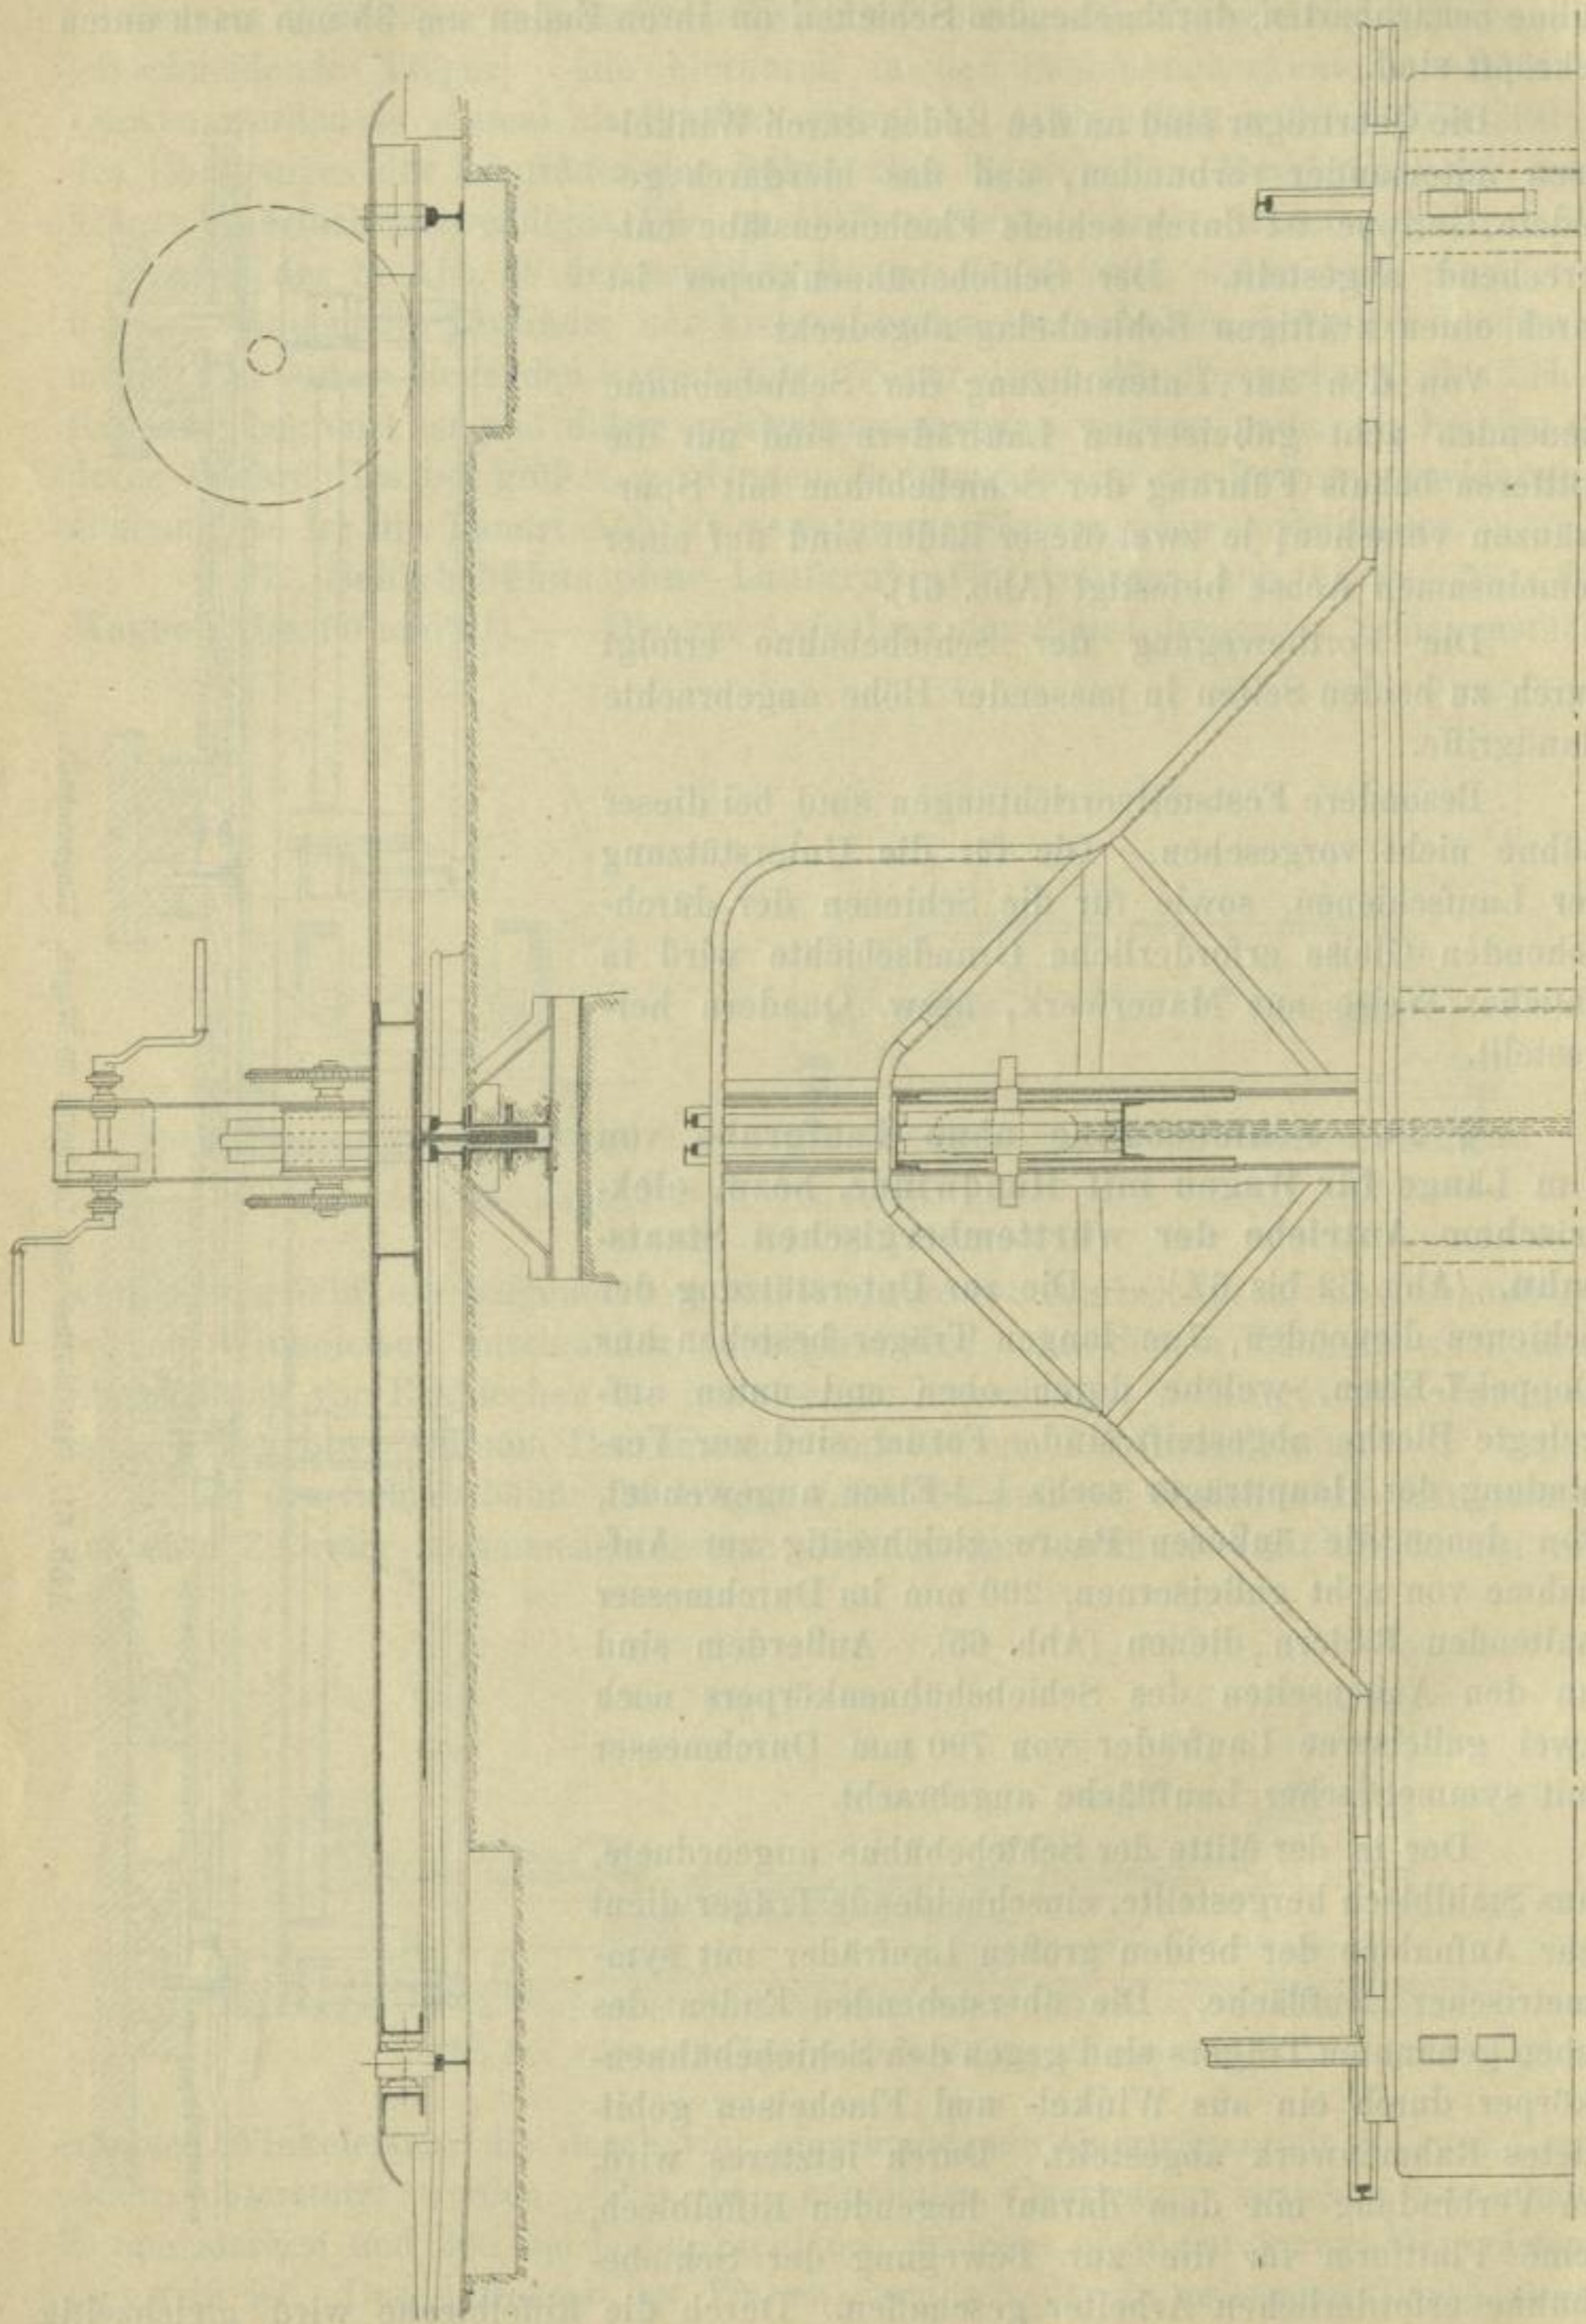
u. 63. Schiebebühne ohne Laufgrube für Wagen mit Handwinde. Grundriß und Längenschnitt.
